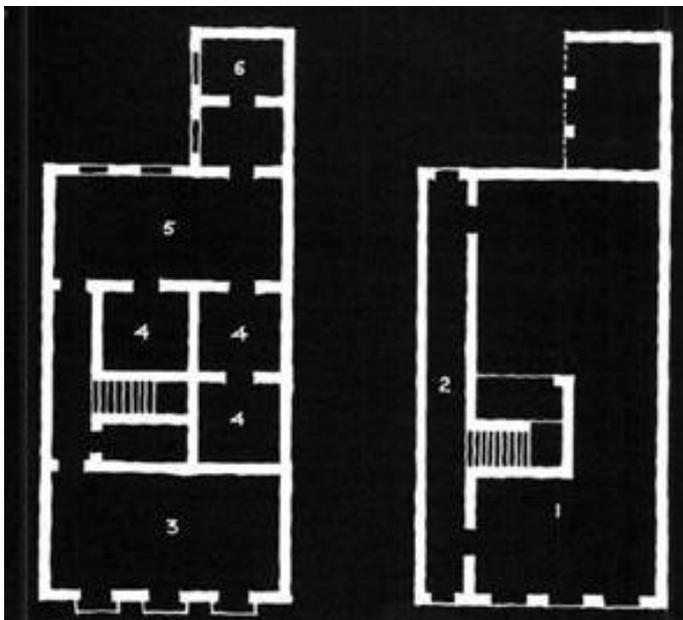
Planta dos casarios de planta simplificada, do período colonial.
